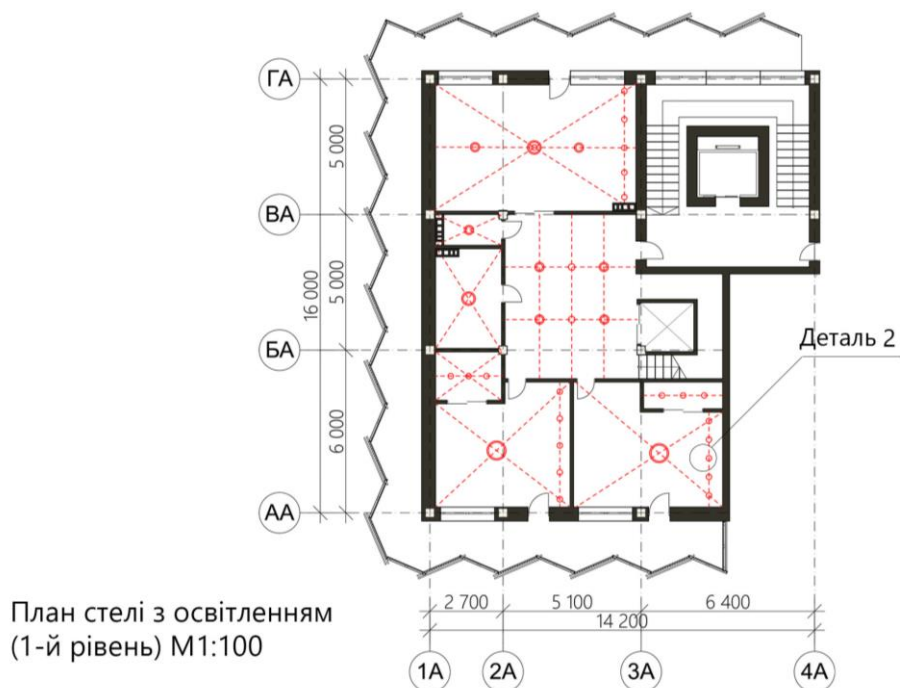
План стелі 1-го рівню з освітленням.
